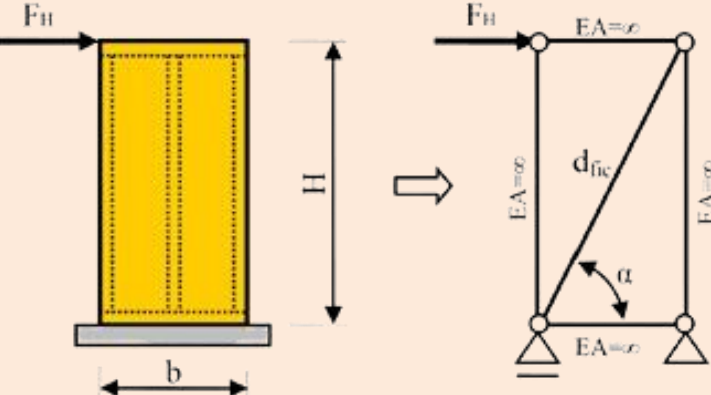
Krachtverdeling bij weglaten structurele elementen [1]
